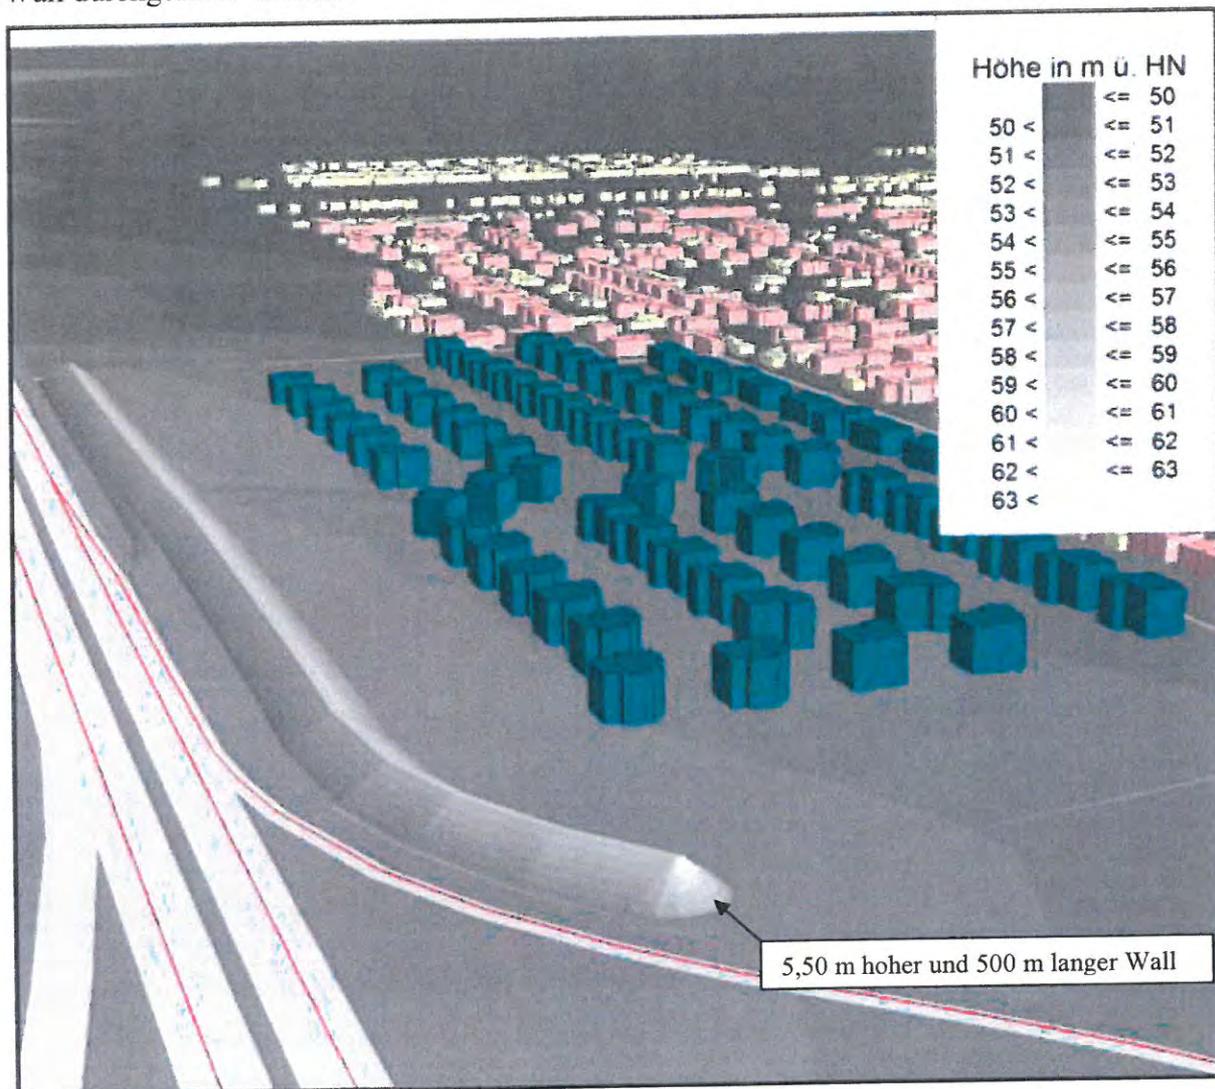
Zu untersuchende Variante eines 500 m langen Lärmschutzwalls im Lageplan des Berechnungsmodells (Vogelperspektive mit Blickrichtung nach Nordosten)
